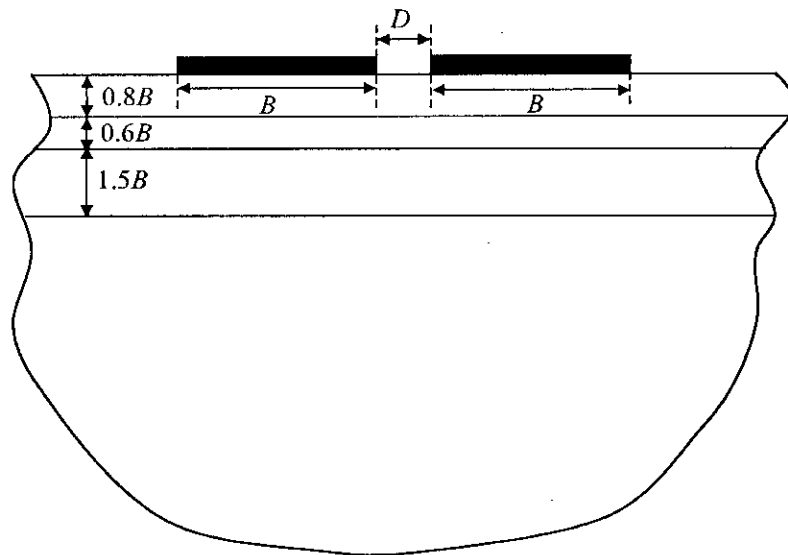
Système fondation-sol-fondation : cas d'un profil de sol multiouche
